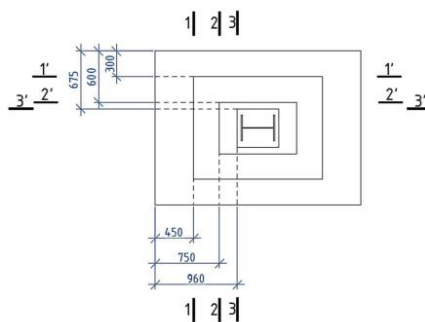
Схема для розрахунку арматури плитної частини фундаменту
